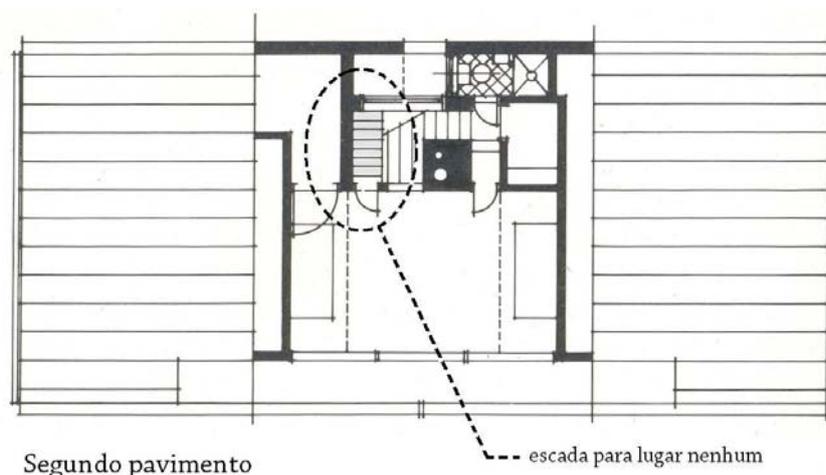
Casa Vanna Venturi. Planta do 2º pavimento. Escada para lugar nenhum.
